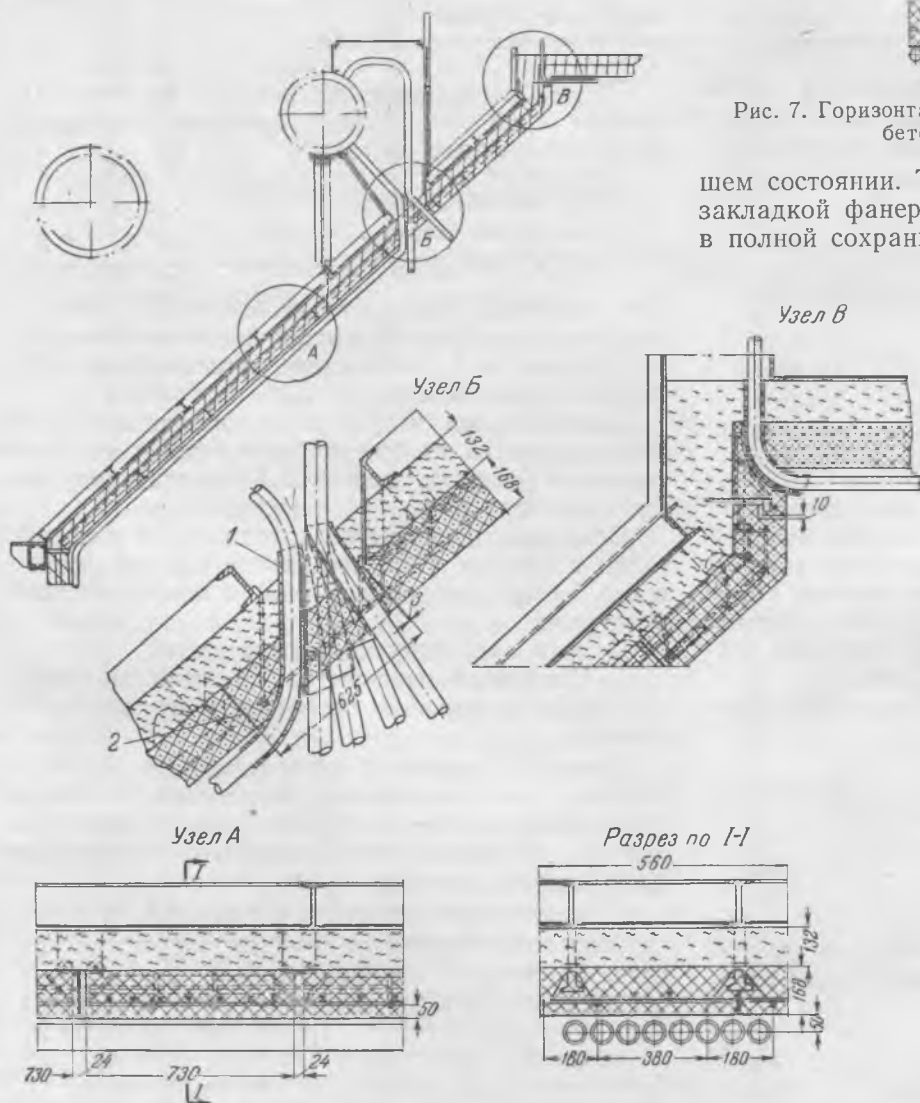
Наклонное перекрытие из огнеупорного бетона для котла ТП-170.
